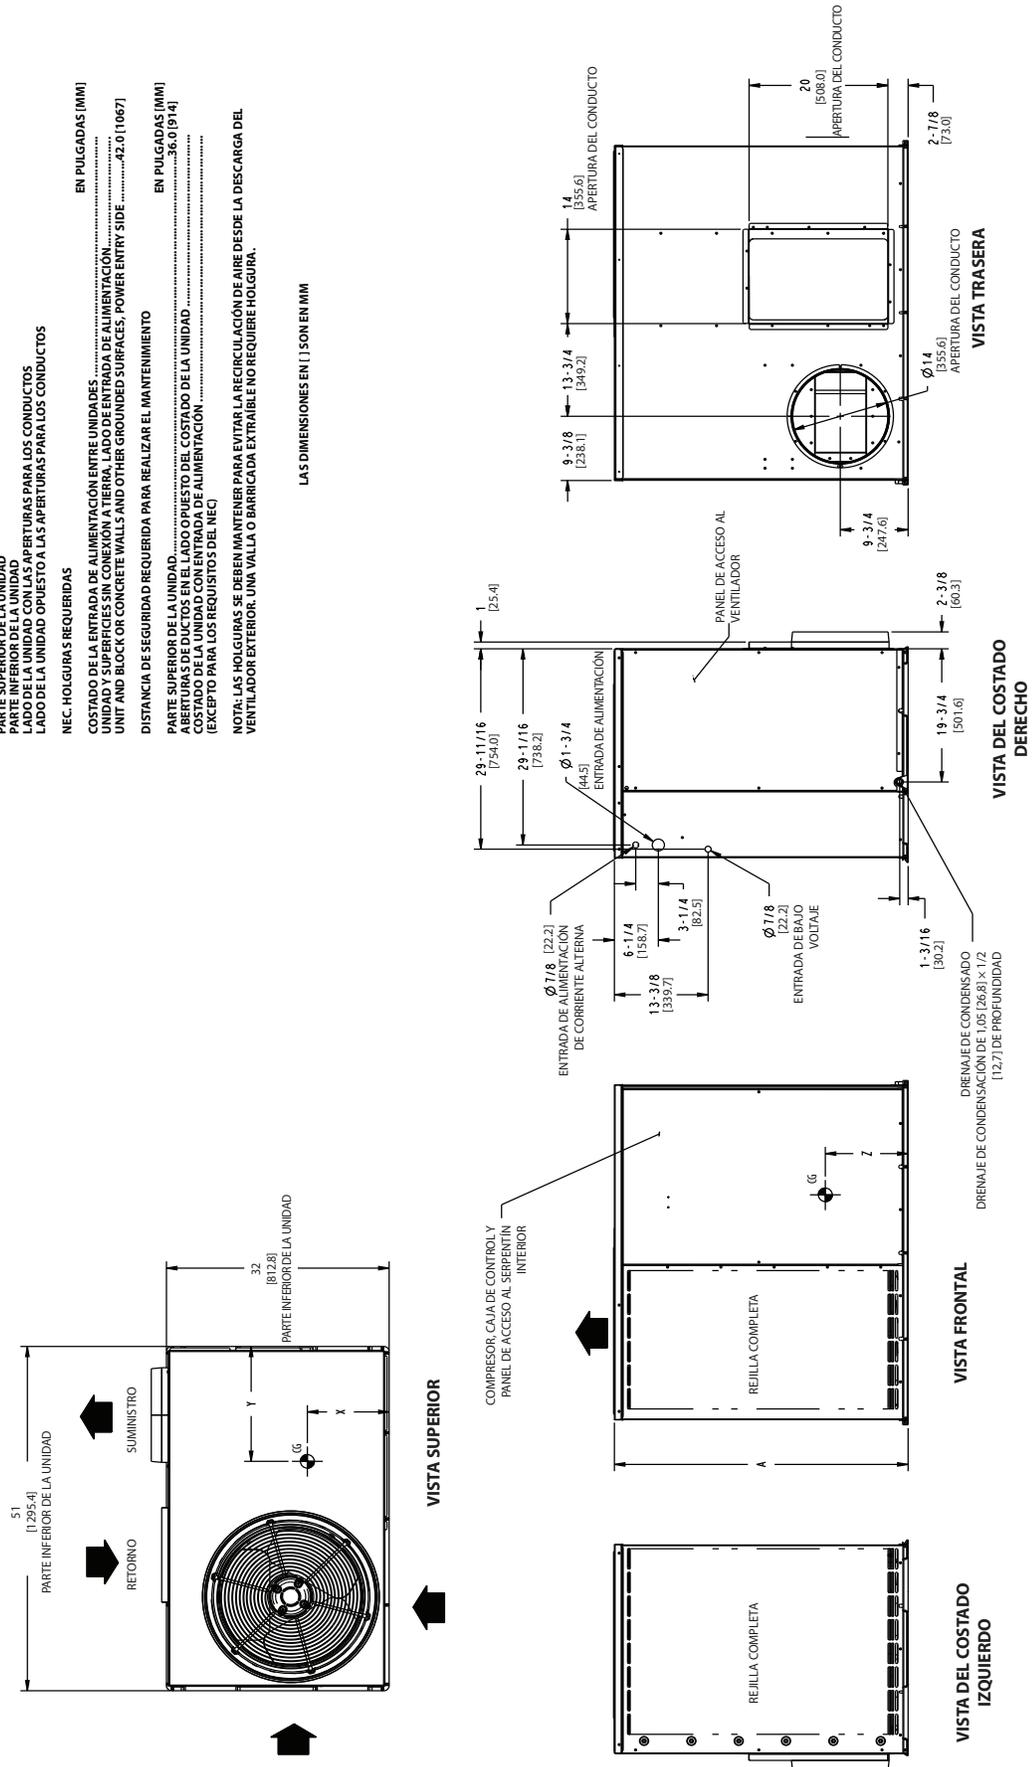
Dimensiones de la base de la unidad, 042-048
